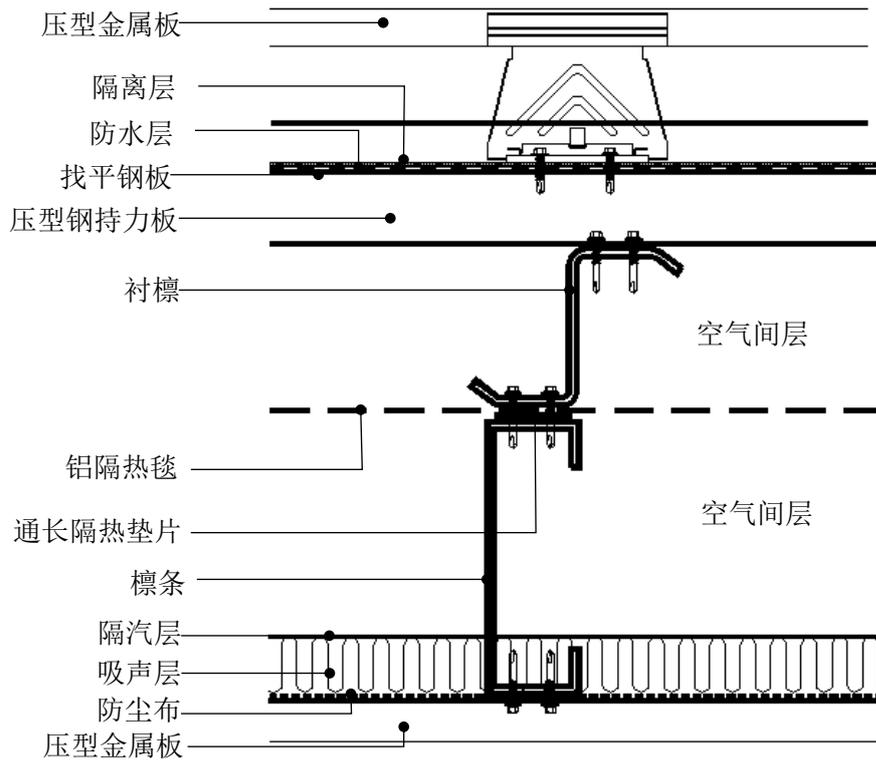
压型金属板屋面构造（防水吸音型）
